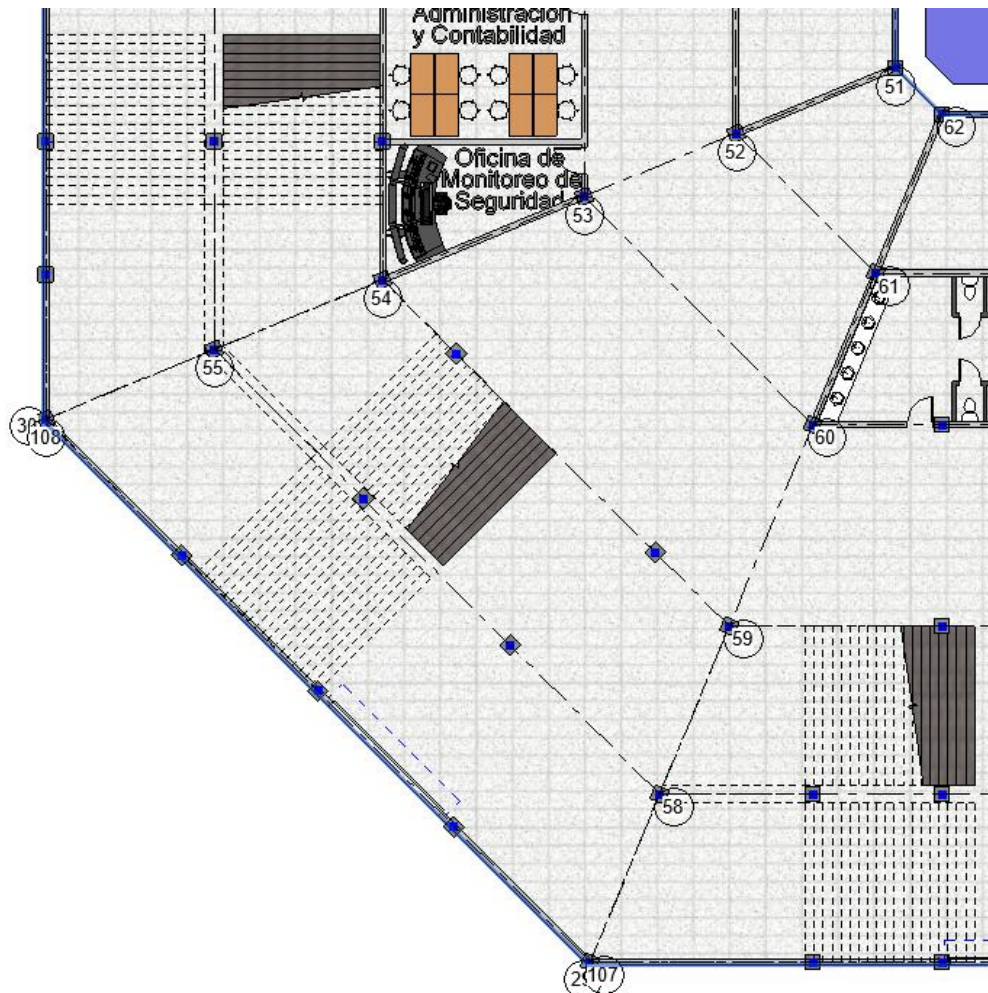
Vista en planta del codo sudoeste. Fuente: elaboración propia.
